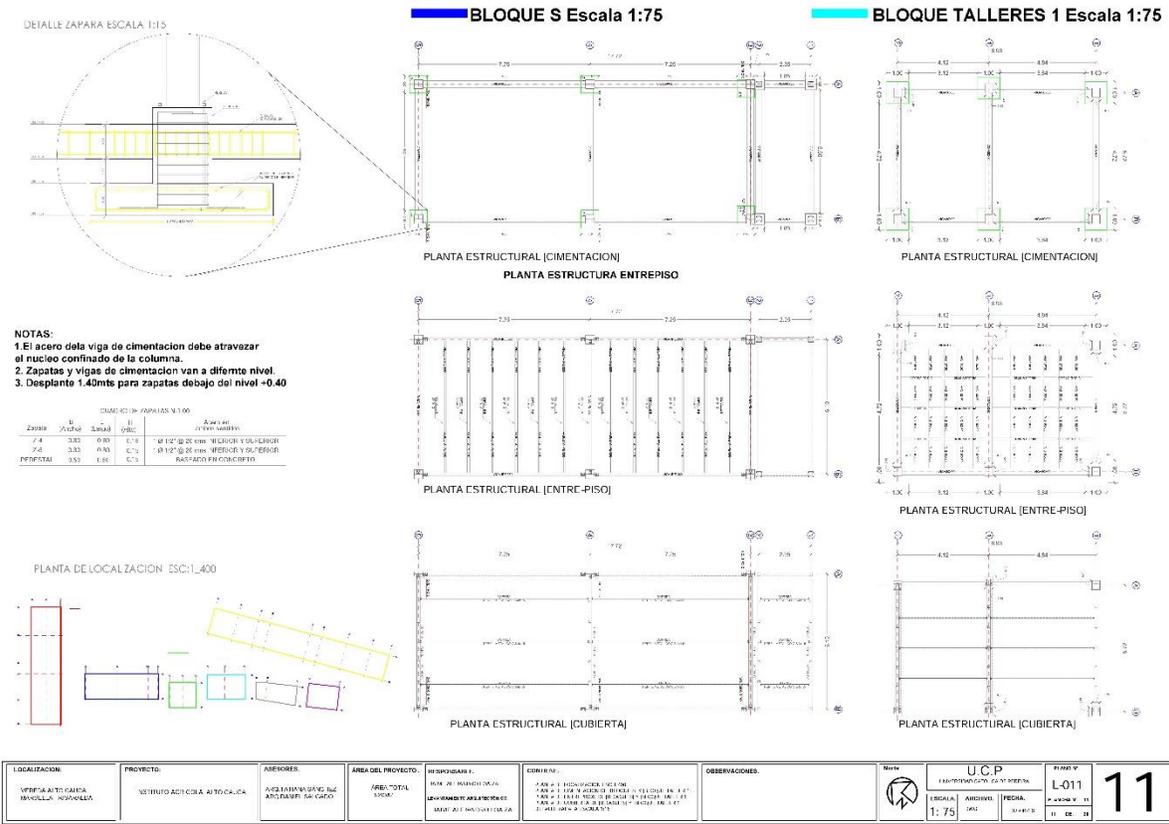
PLANOS: CIMENTACION, ESTRUCTURAL, ENTREPISO DE BLOQUE SOCIAL Y TALLERES 1, DETALLES.
